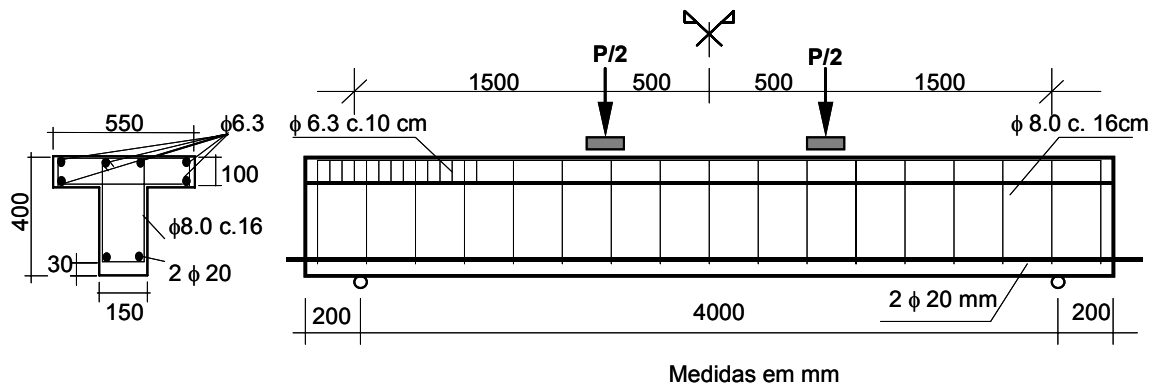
Seção transversal, detalhamento da armadura e esquema de ensaio (Castro et al, 2004)
